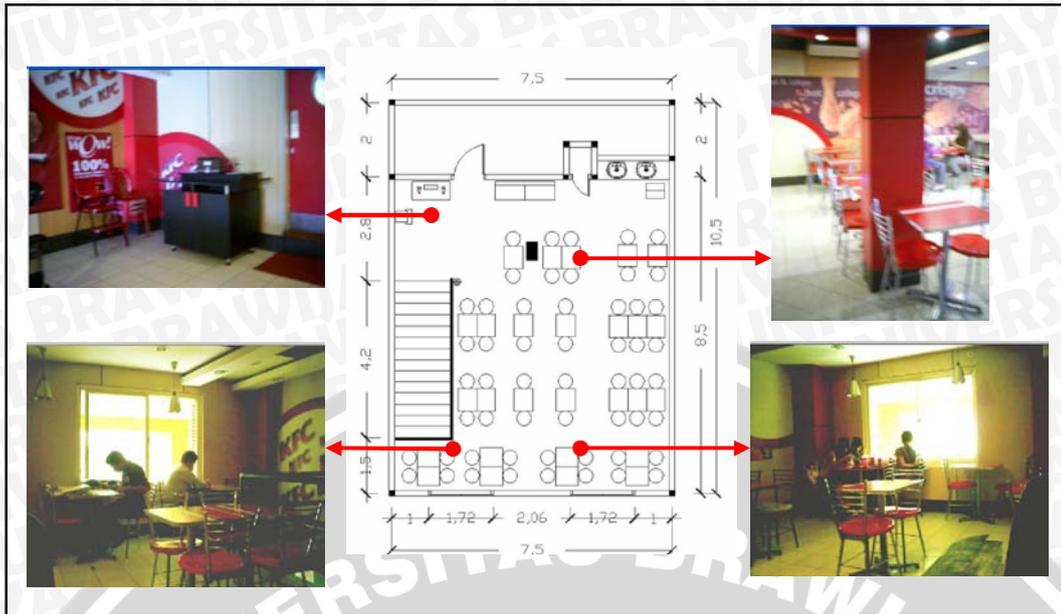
Tangga penghubung lantai dan lantai 2
